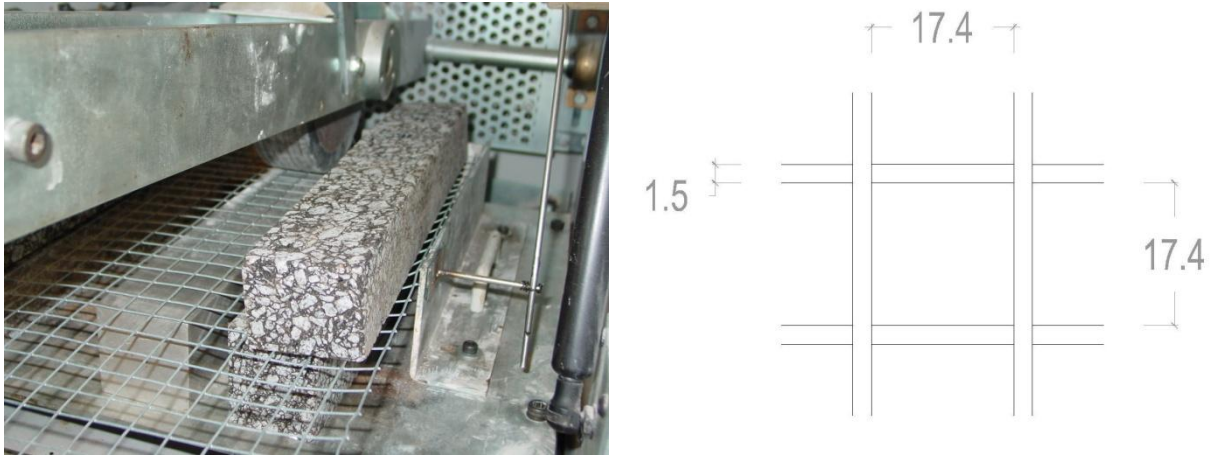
Rede metálica utilizada no ensaio WTT (medidas em mm).
